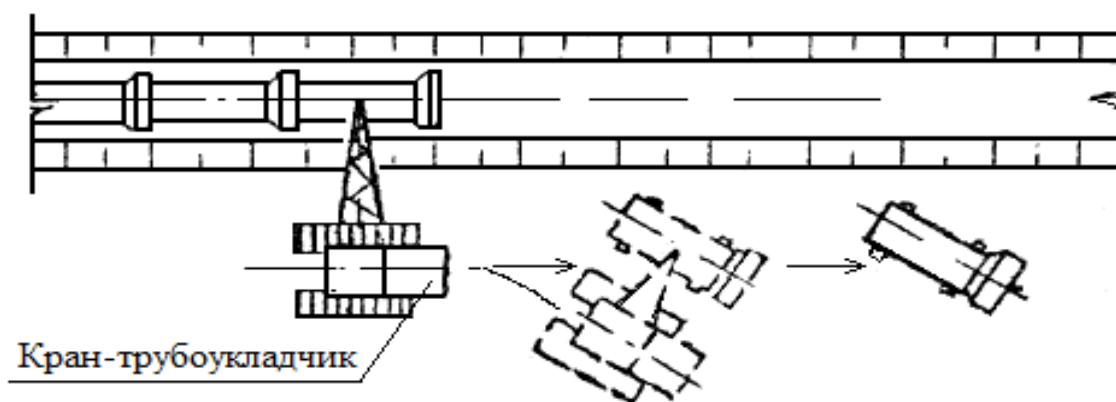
Раскладка раструбных труб вдоль траншеи «в елочку» с укладкой краном-трубоукладчиком
